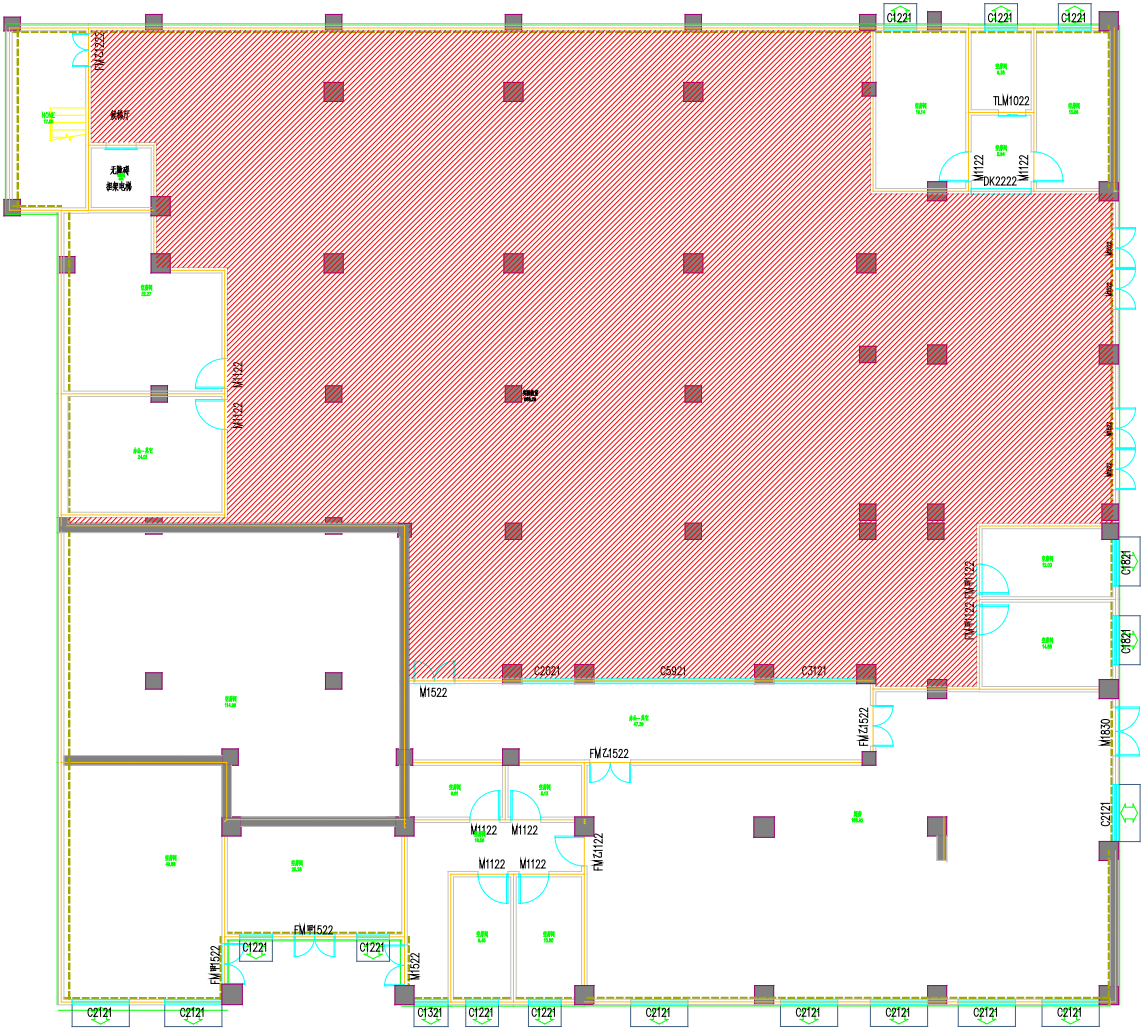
受建筑外部噪声影响的典型房间楼层平面图
